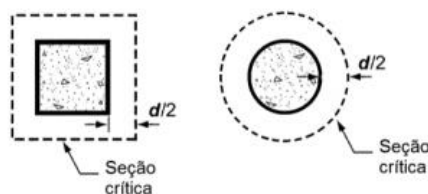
Perímetro crítico afastado $d/2$ do apoio (SANTOS, 2016)
